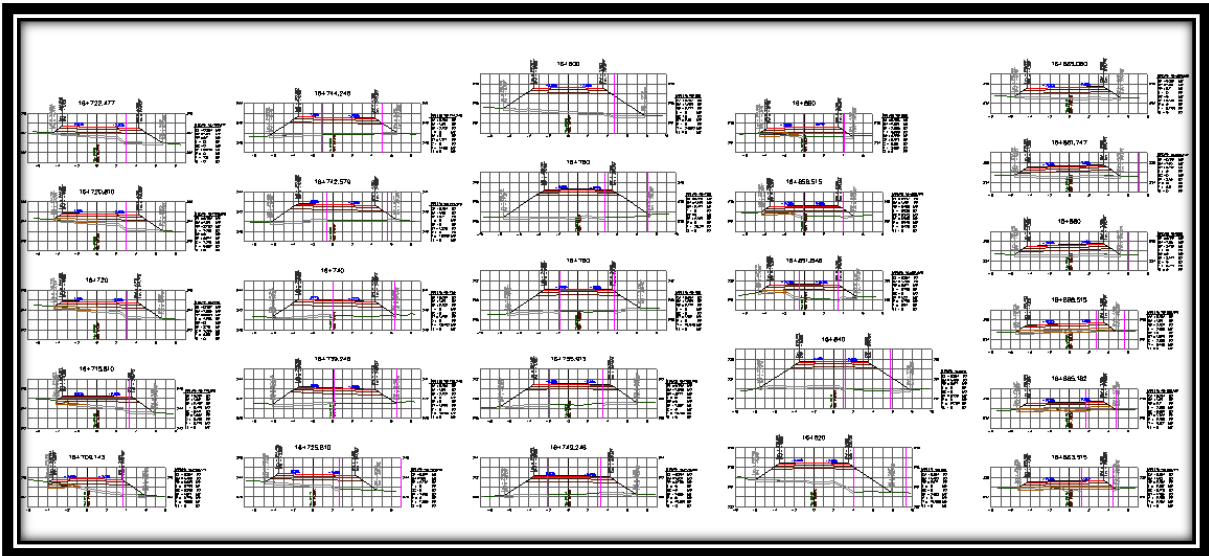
Secciones de construcción del km 16+709.143 al km 16+885.080.
